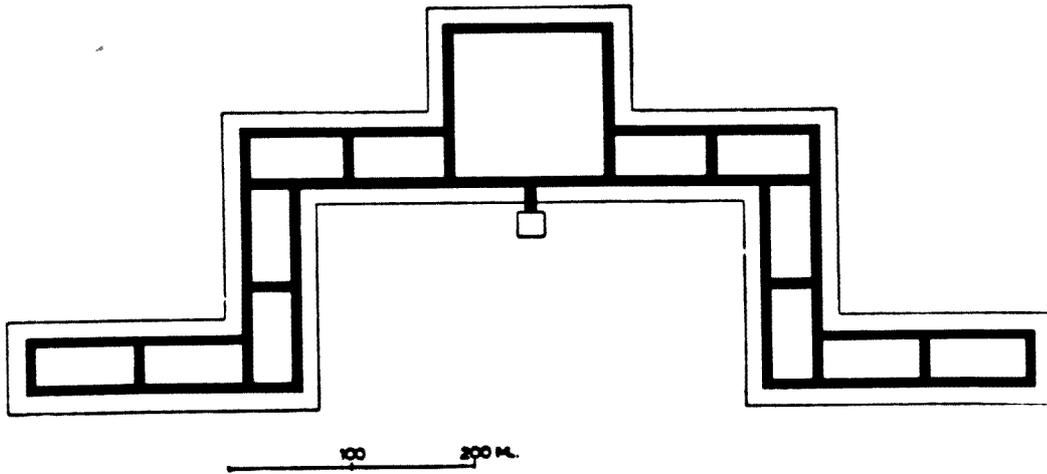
Planta esquemática del Falansterio de Fourier, tomada de la descripción de 1841; en negro aparecen las calles interiores elevadas.
